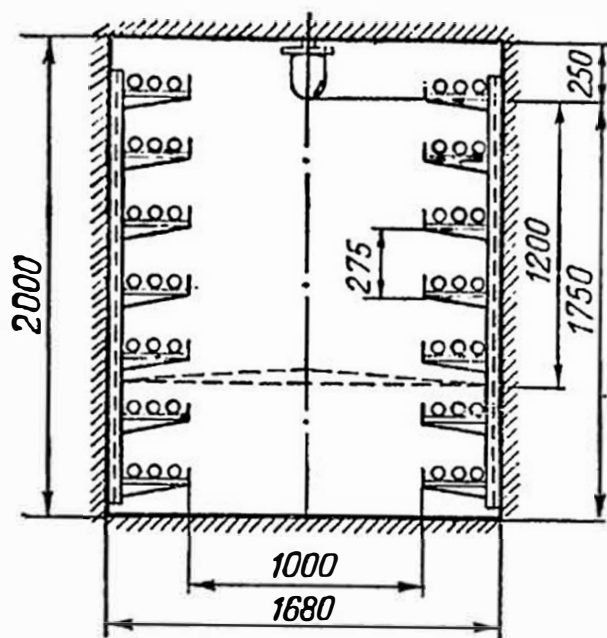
Проходной кабельный туннель прямоугольного сечения
